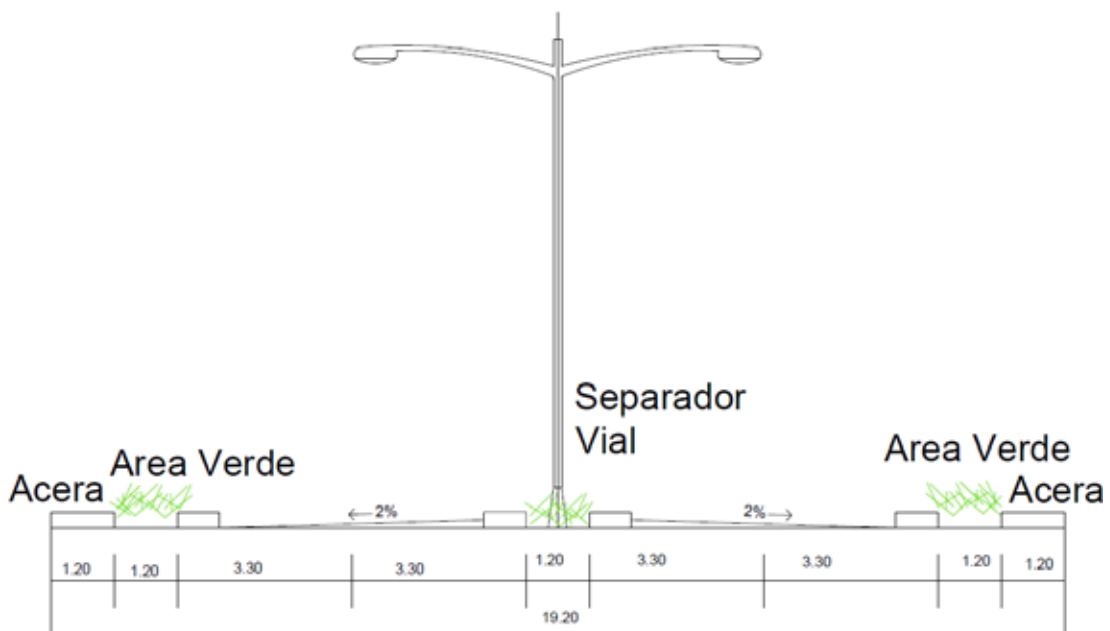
Perfil planteado de la Av. Simón Rodríguez
